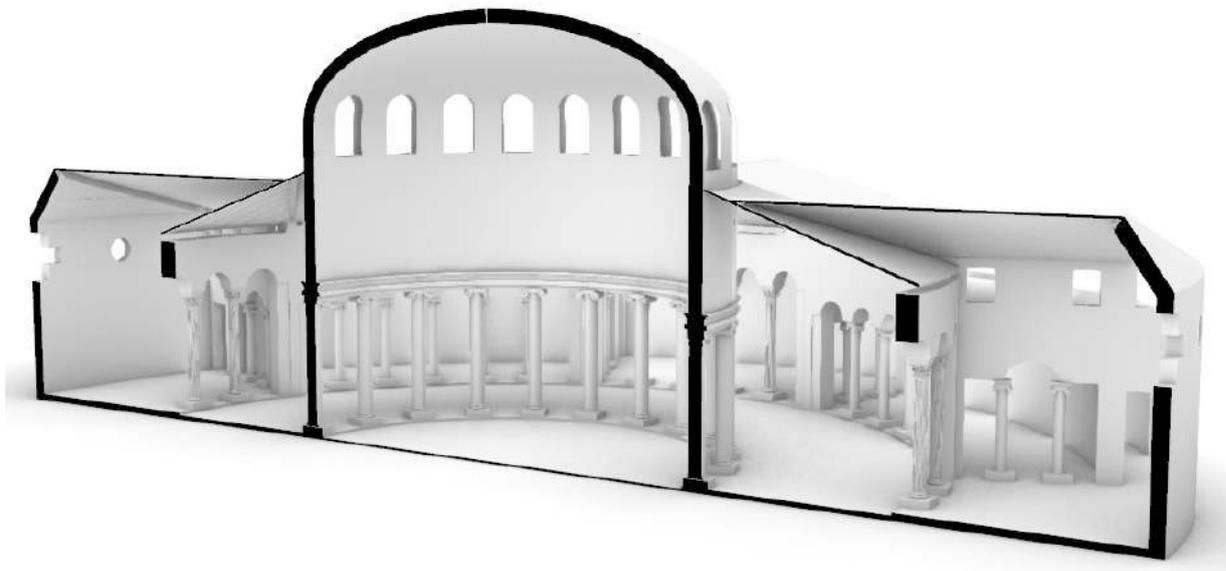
Santo Stefano Rotondo, 3D Schnitt des ursprünglichen Baus
